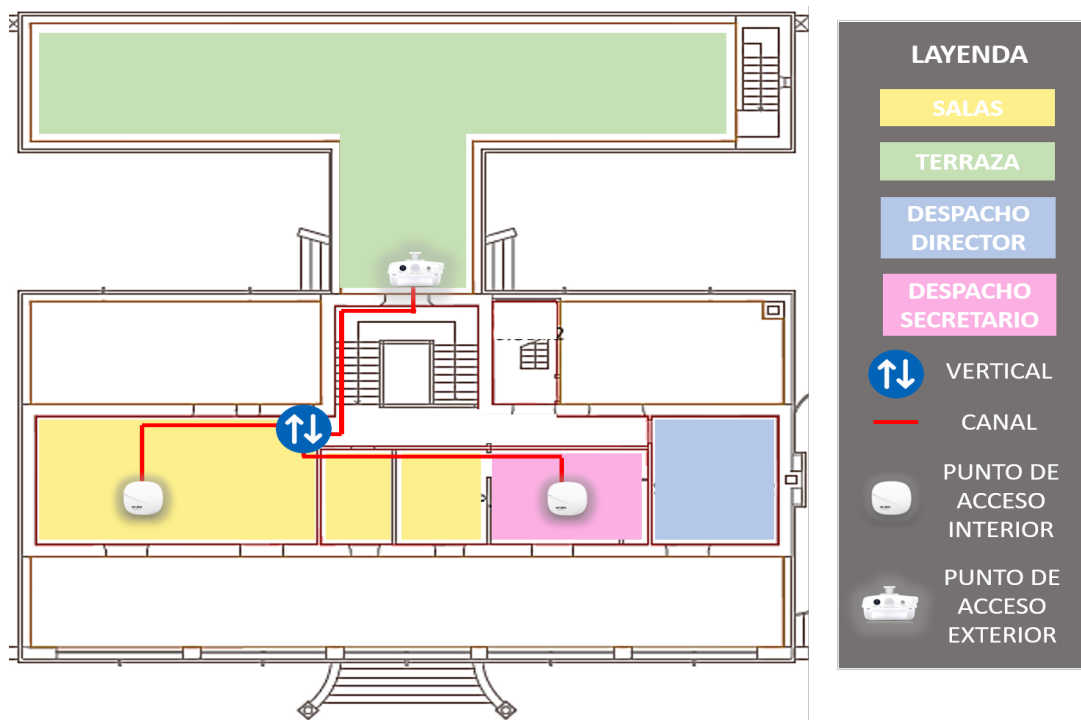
Cableado estructurado nuevo de la planta primera.
